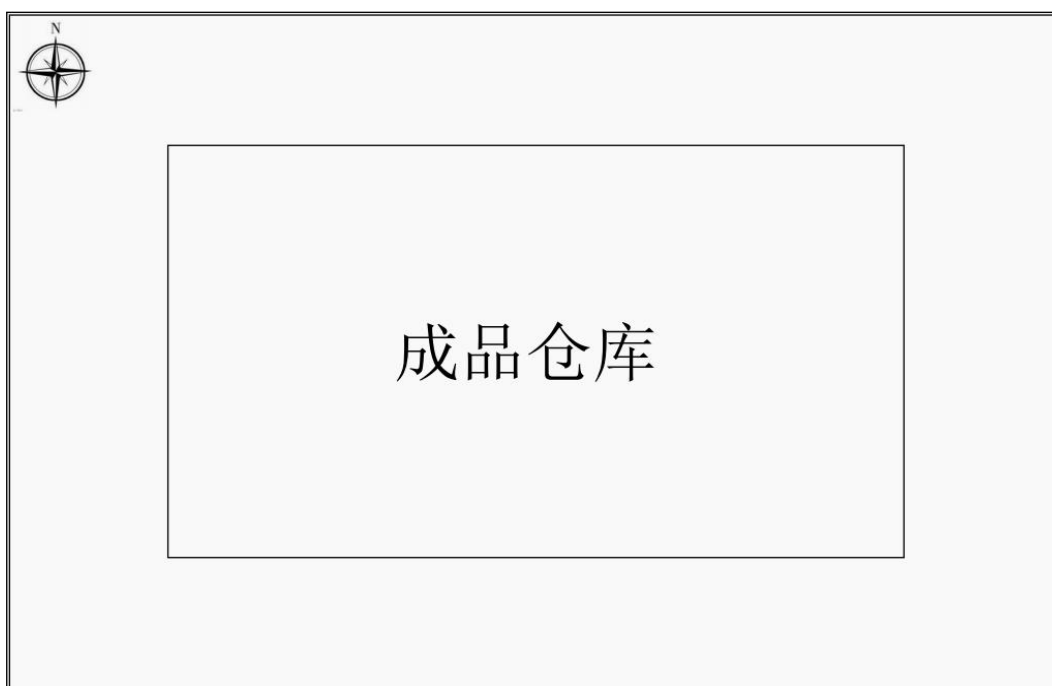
建设项目环评审批 1#厂房二楼平面布置图
